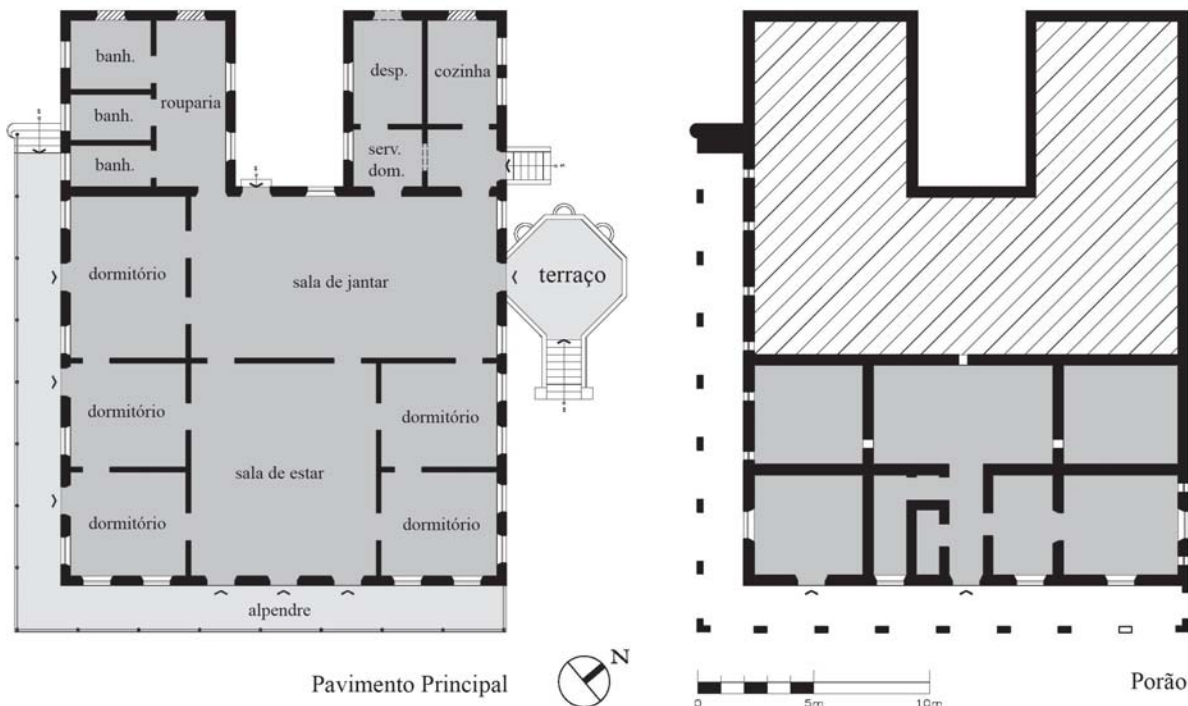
Planta do casarão da fazenda Serra Negra, Botucatu. Levantamento e desenho: V. Benincasa.
